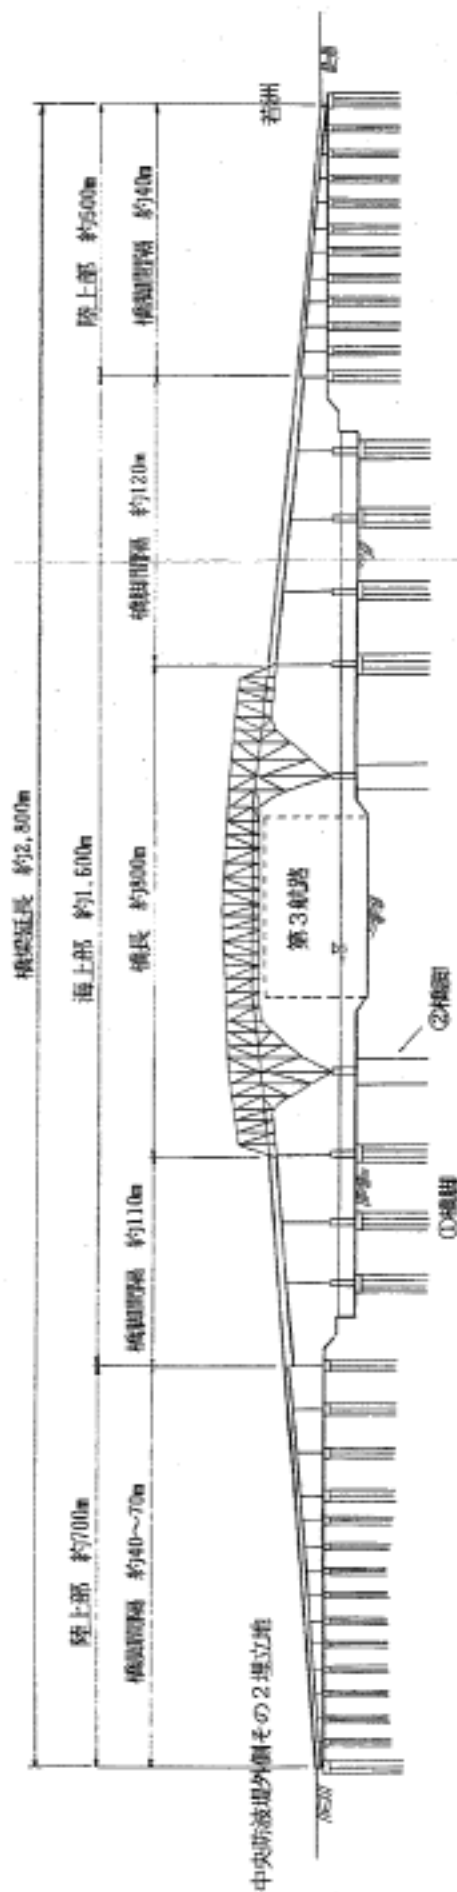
(4) 航路橋脚部橋梁全体断面図
